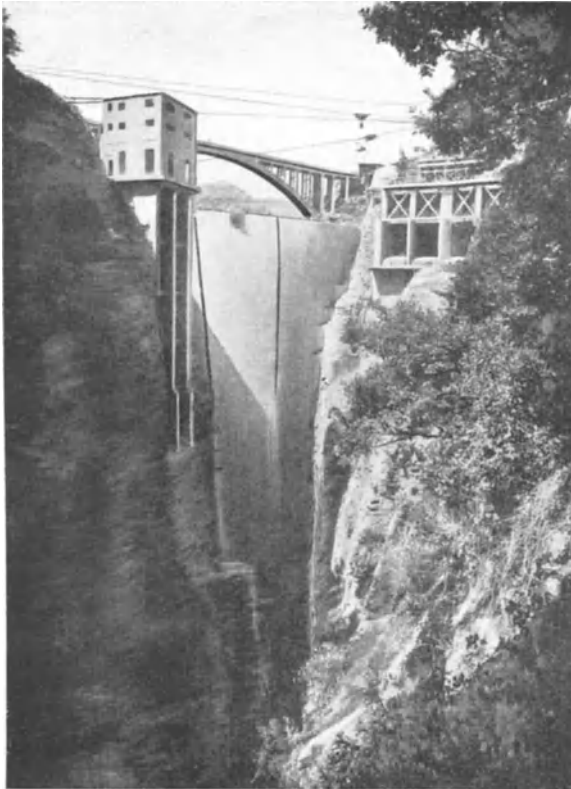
Sautée-Staumauer. Ansicht von der Wasserseite mit Einlaufbauwerk (links) und Hochwasserüberlauf rechts.
